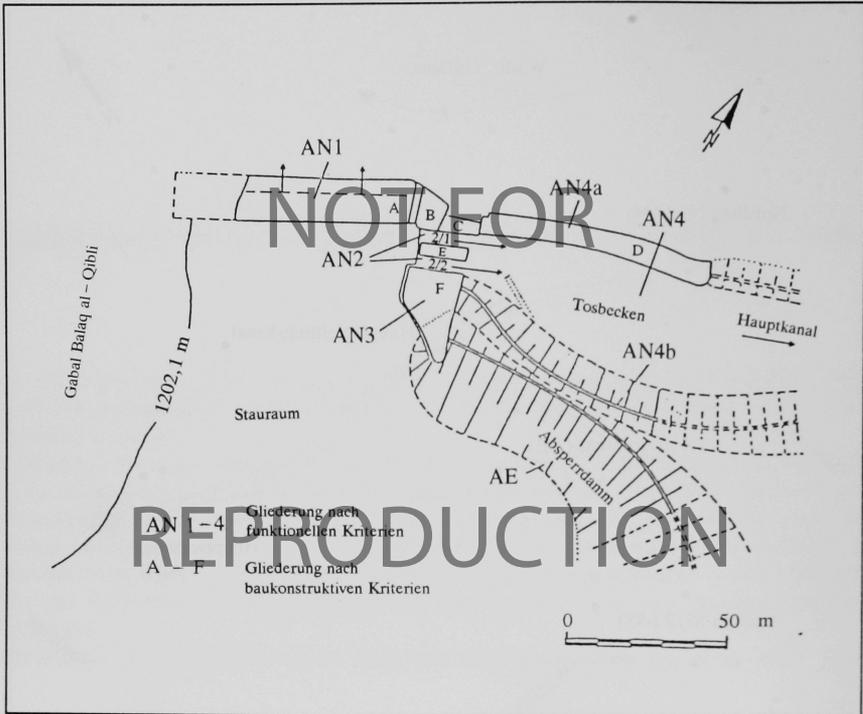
Grundriß der Bauanlage N1 (Nordbau).
